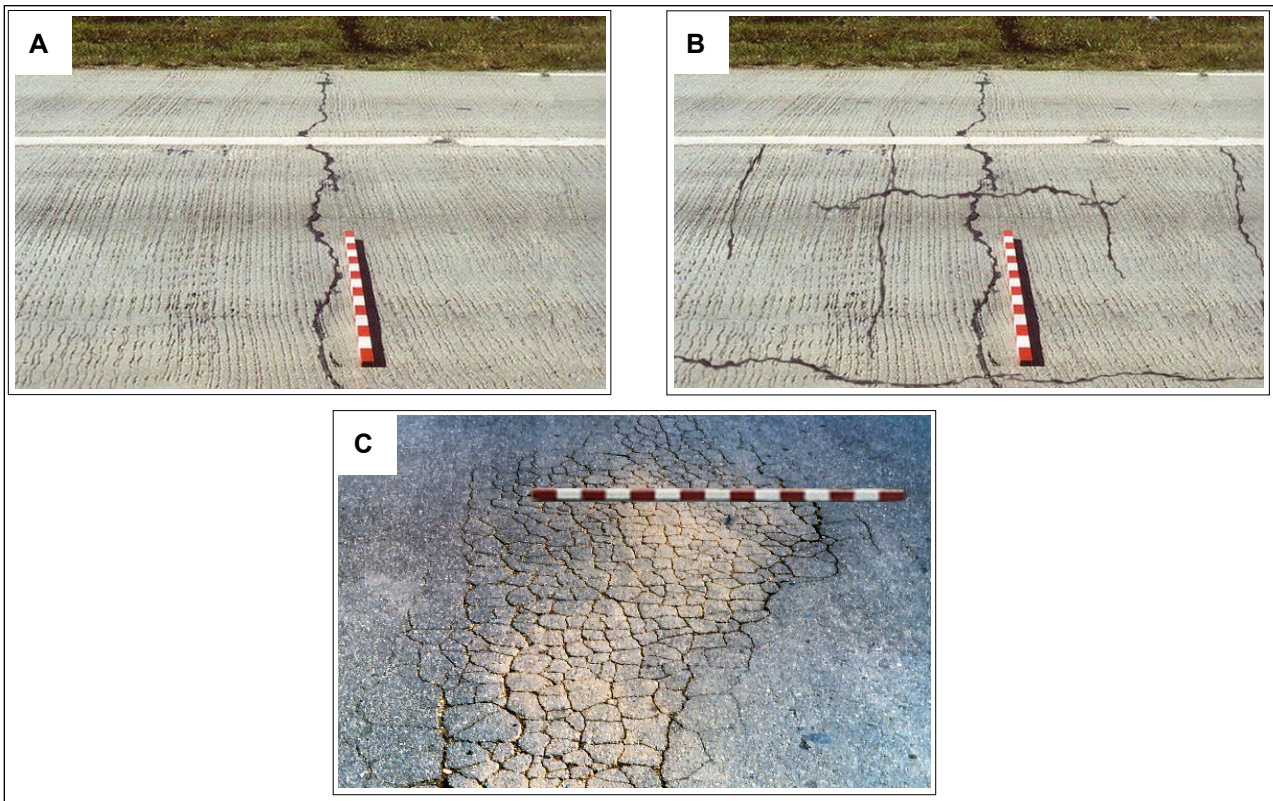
Différentes extensions de la fissuration en surface. A) fissure unique isolée, B) fissures disposées en bloc et C) fissures en bloc très dense, faïençage ou « alligator cracking »
